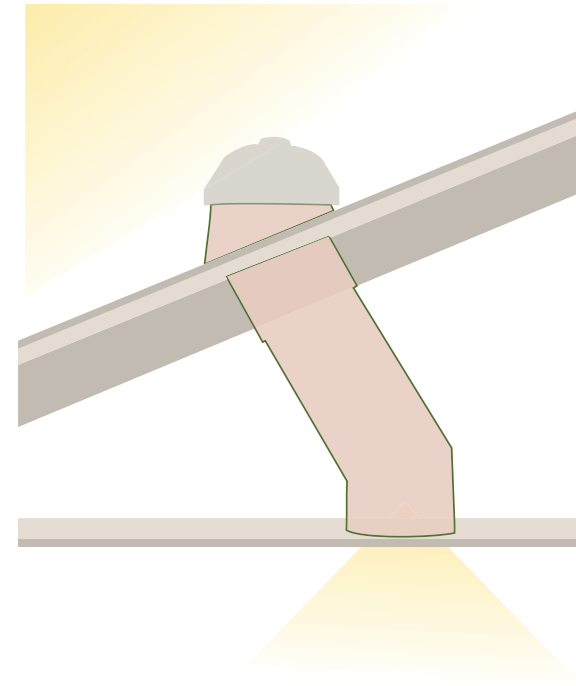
Detalle de tubo solar | Fuente: Elaboración propia
